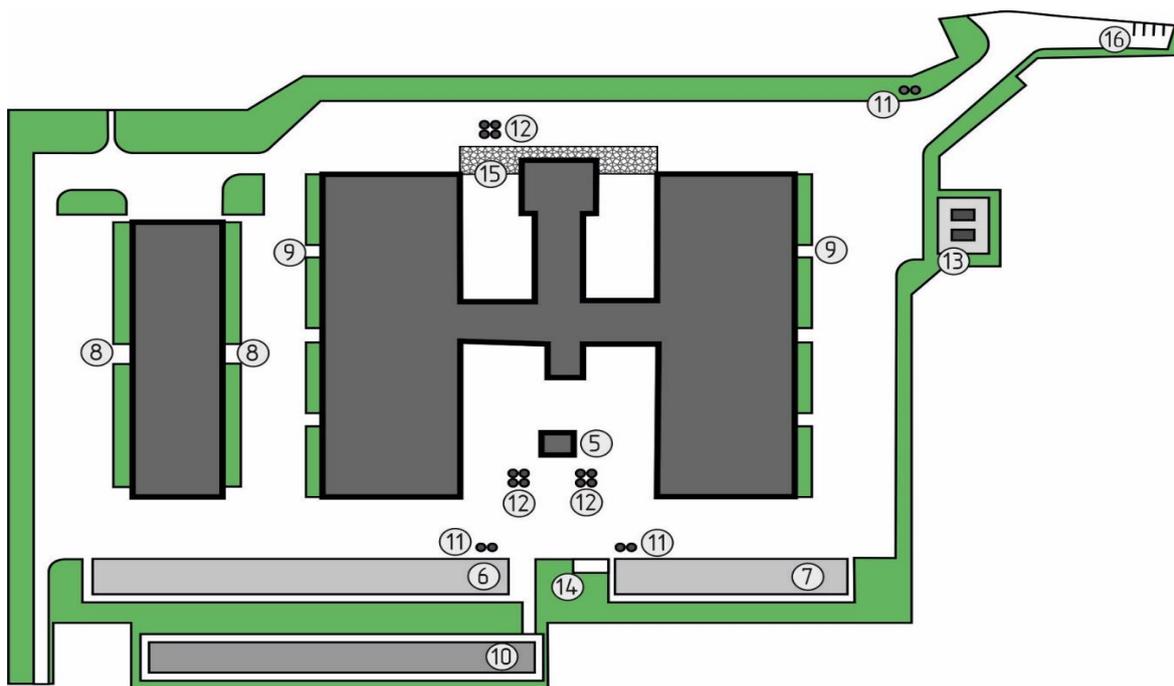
Схема генерального плана молочно-товарной фермы вблизи н. п. Озераны:
